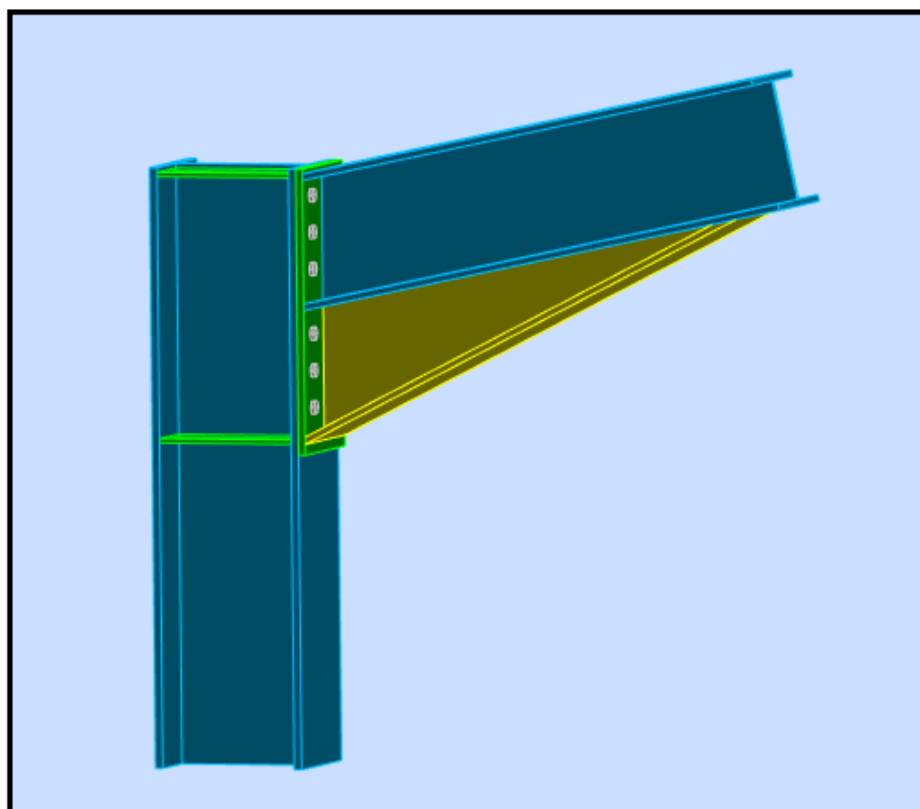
Vue 3D de l'assemblage poteau-traverse.
